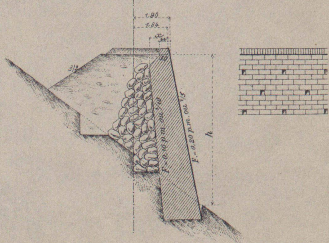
Mur de pied en maçonnerie de pierres sèches
